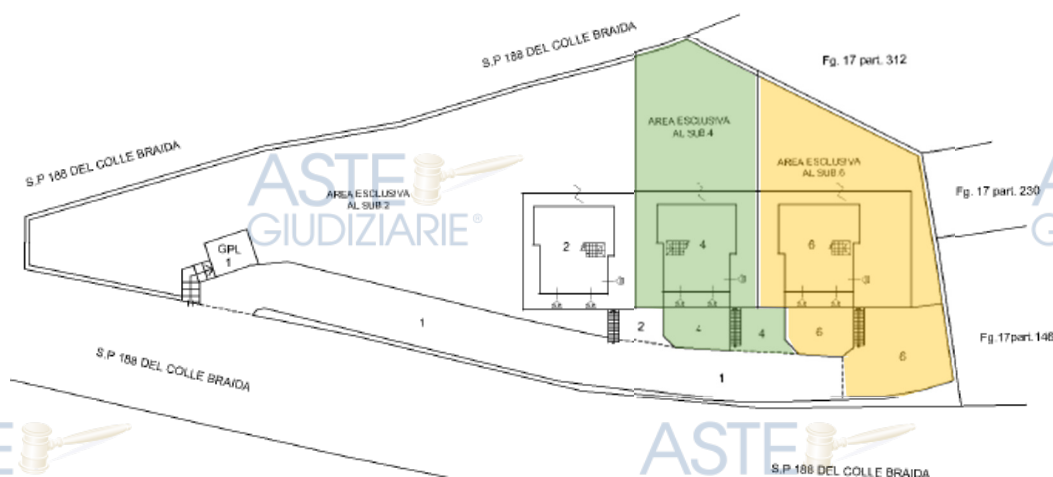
Planimetria castale del piano terra dei tre villini (anche All. n. 5) costruiti dalla *: quelli pignorati sono indicati con i subalterni 4 (area verde in posizione centrale) e 6 (area gialla sulla destra)
